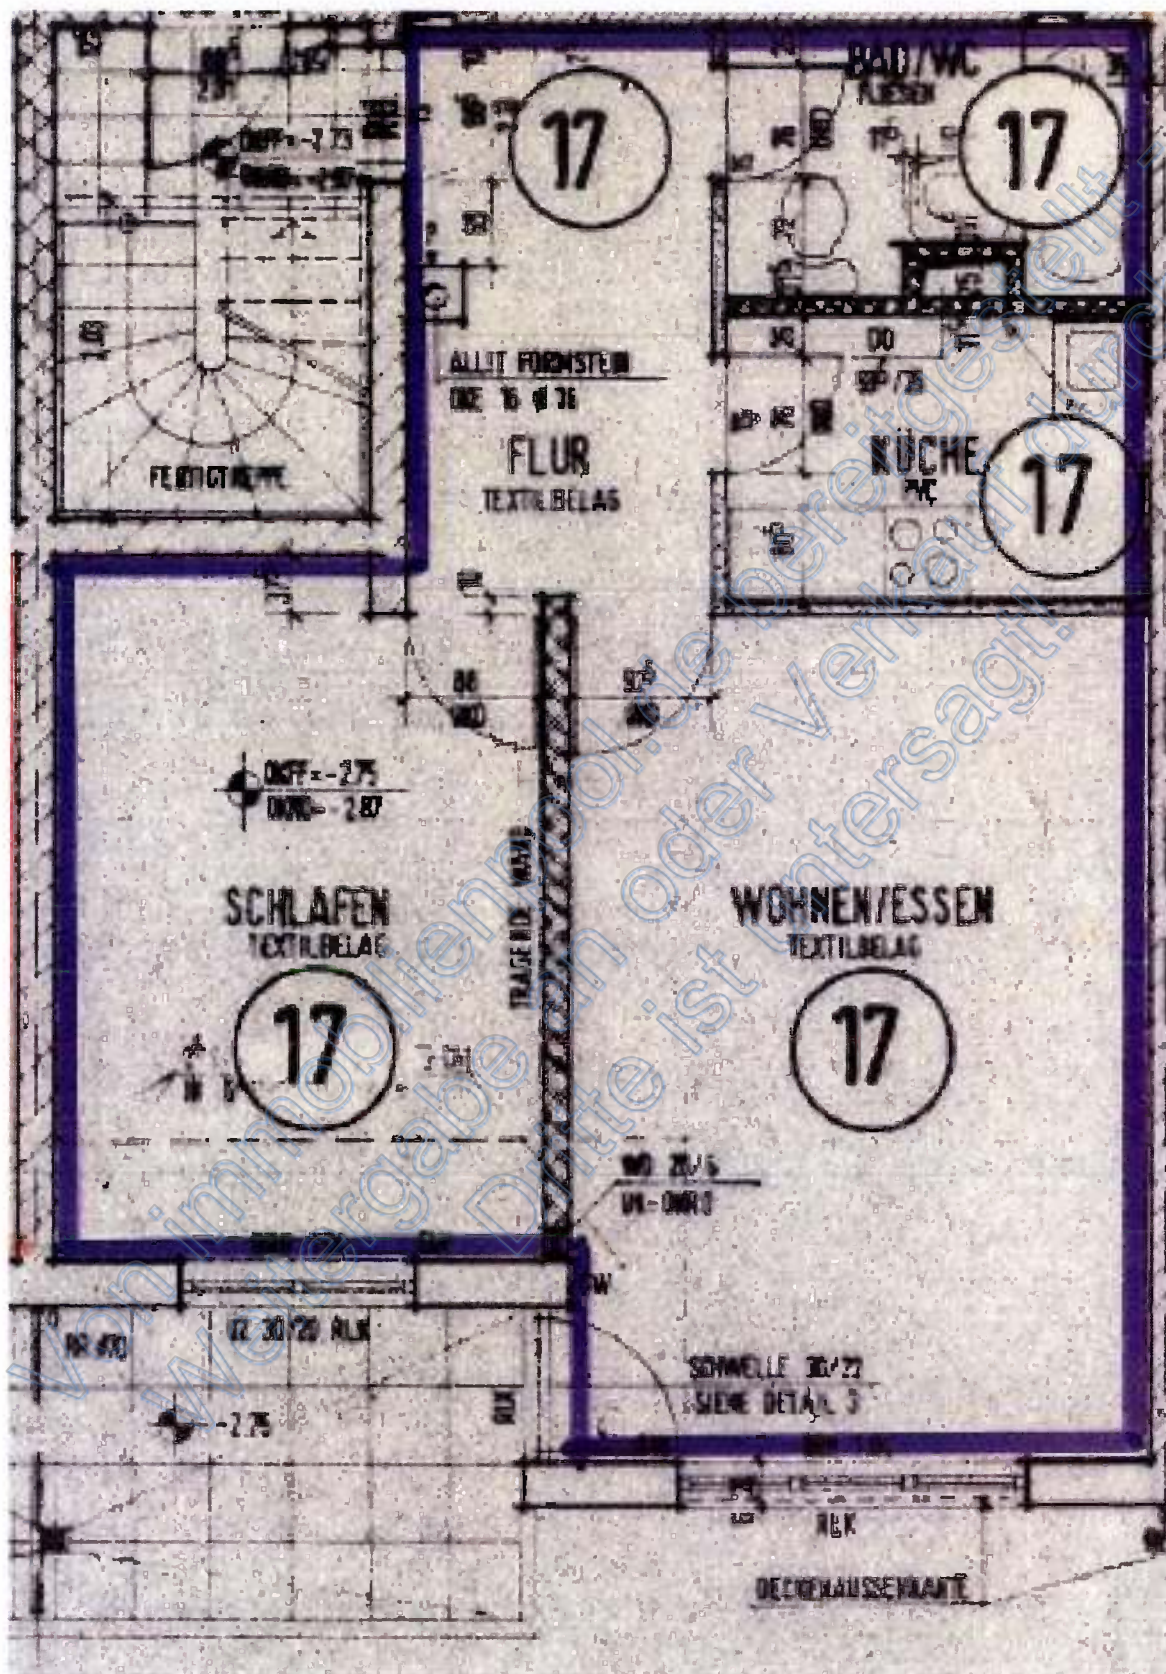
Auszug Grundriss Kellergeschoss, Haus 13, Henry-Moisand-Str. 20; Wohnung Nr. 17; Quelle: Bauakte
